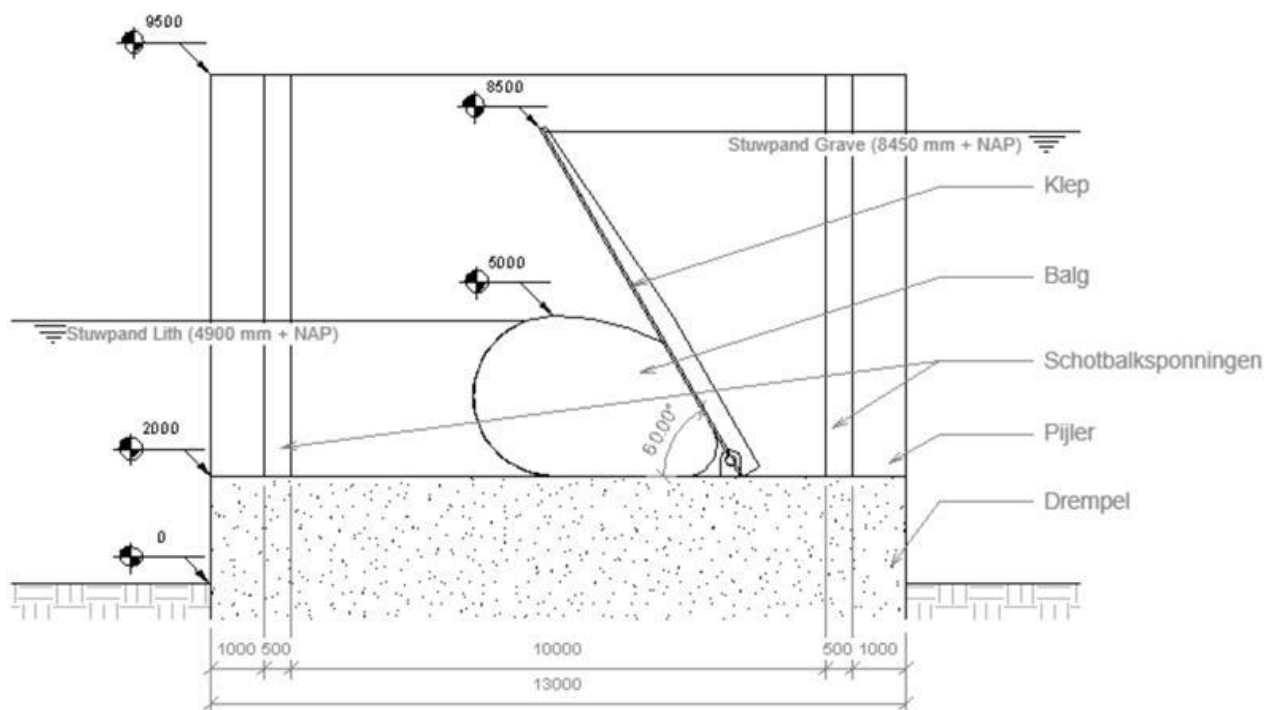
Stuwopening vanaf benedenstroomse zijde, klep-balgstuw in gesloten stand.
